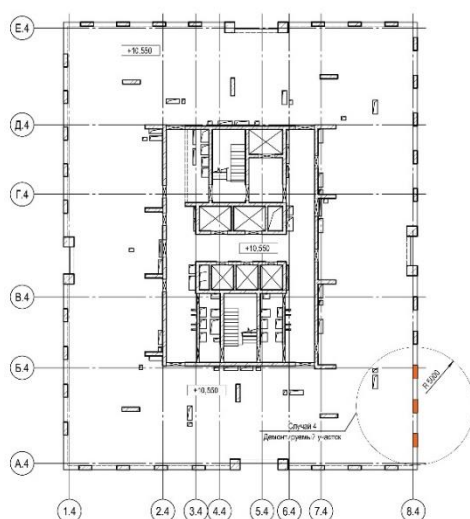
Корпус К-4. Схема аварийного случая 4
